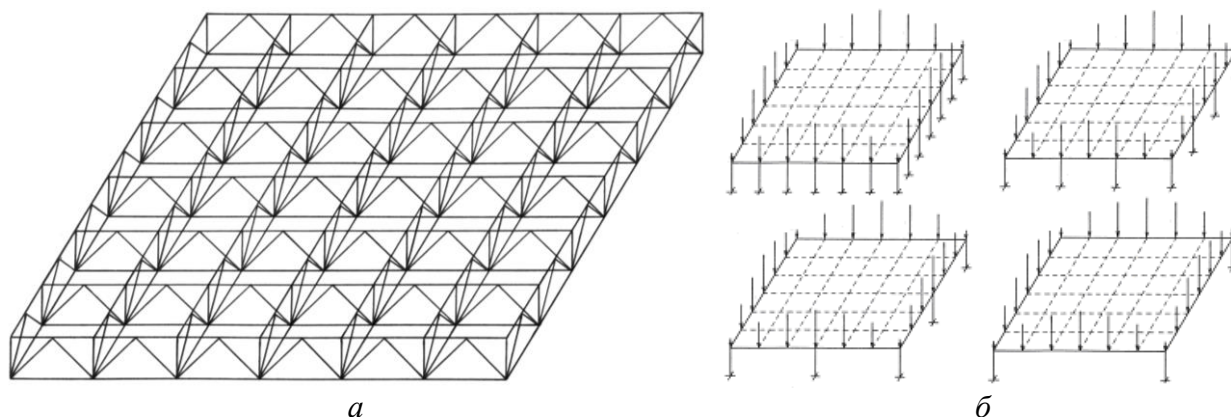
Схемы ортогональной системы перекрестных ферм (а) и ее опорных контуров (б)
